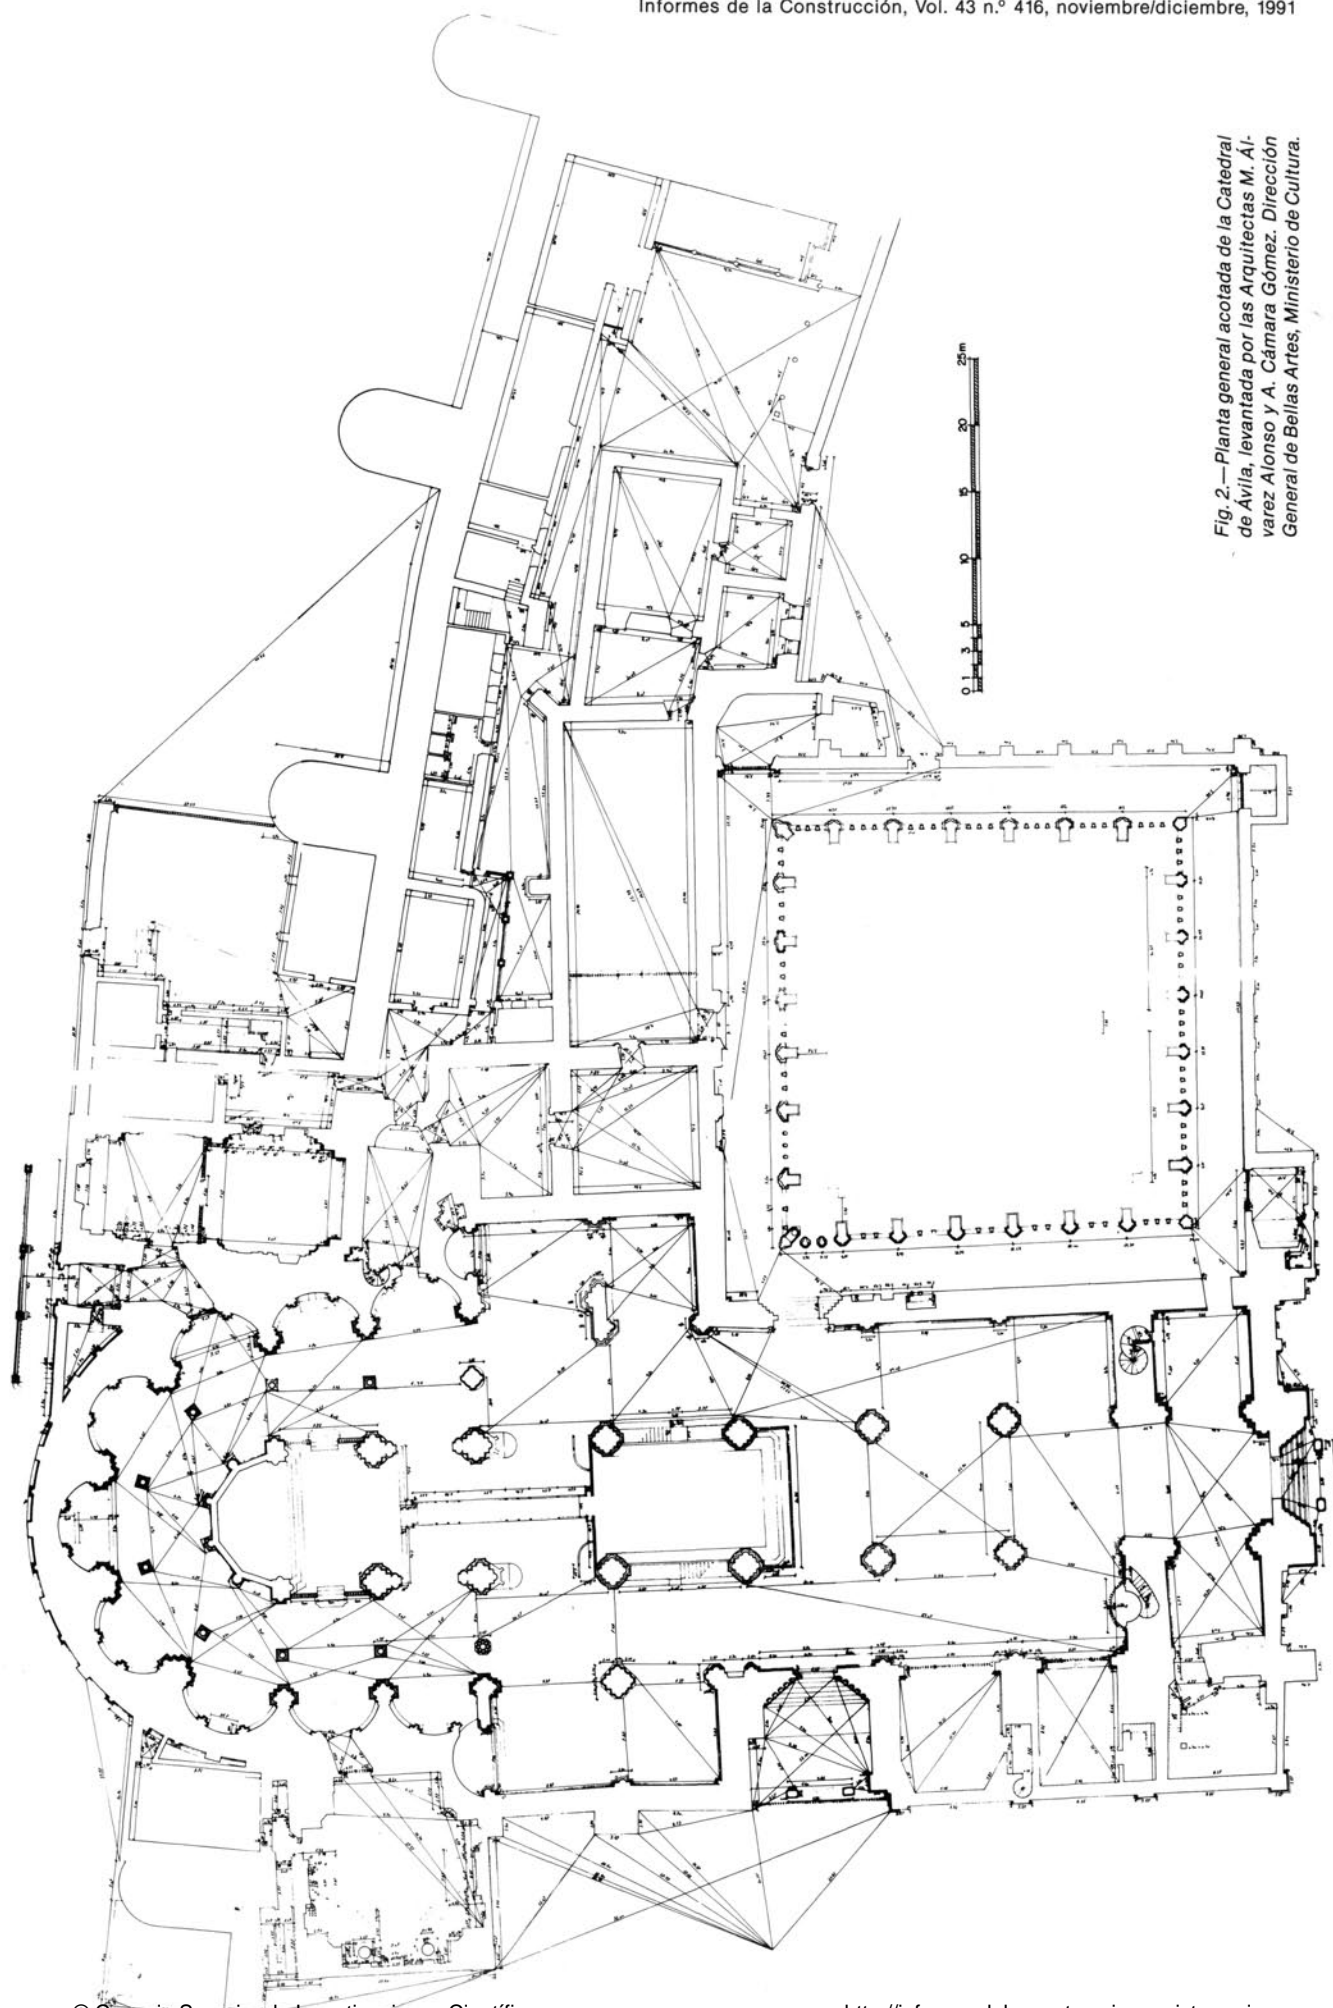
Planta general acotada de la Catedral de Ávila, levantada por las Arquitectas M. Álvarez Alonso y A. Cámara Gómez. Dirección General de Bellas Artes, Ministerio de Cultura.
